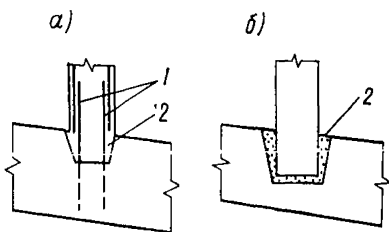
Примеры примыкания монолитных (а) и сборных (б) внутренних стен к наружным с устройством паза (2)
